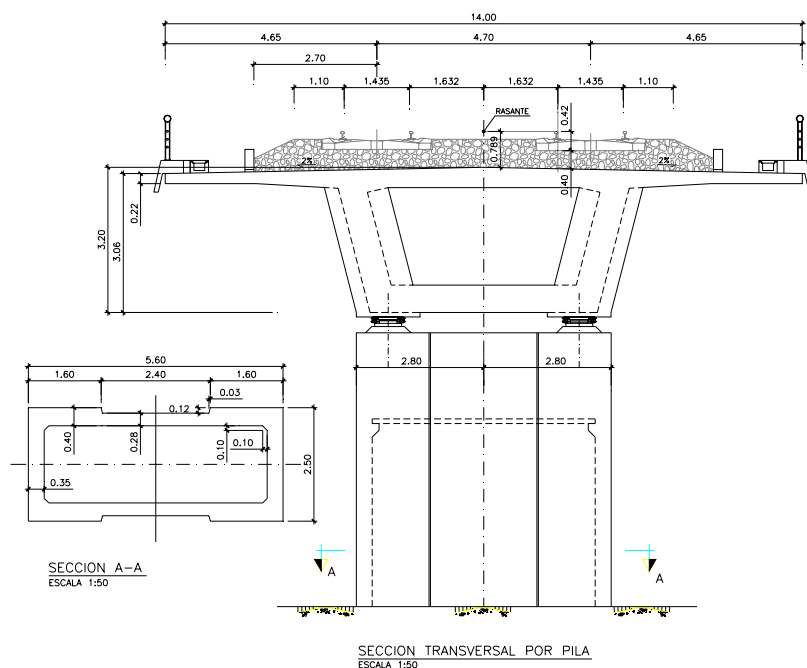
Secções tipo do pilar e do tabuleiro – Viaducto de Rio Portos
